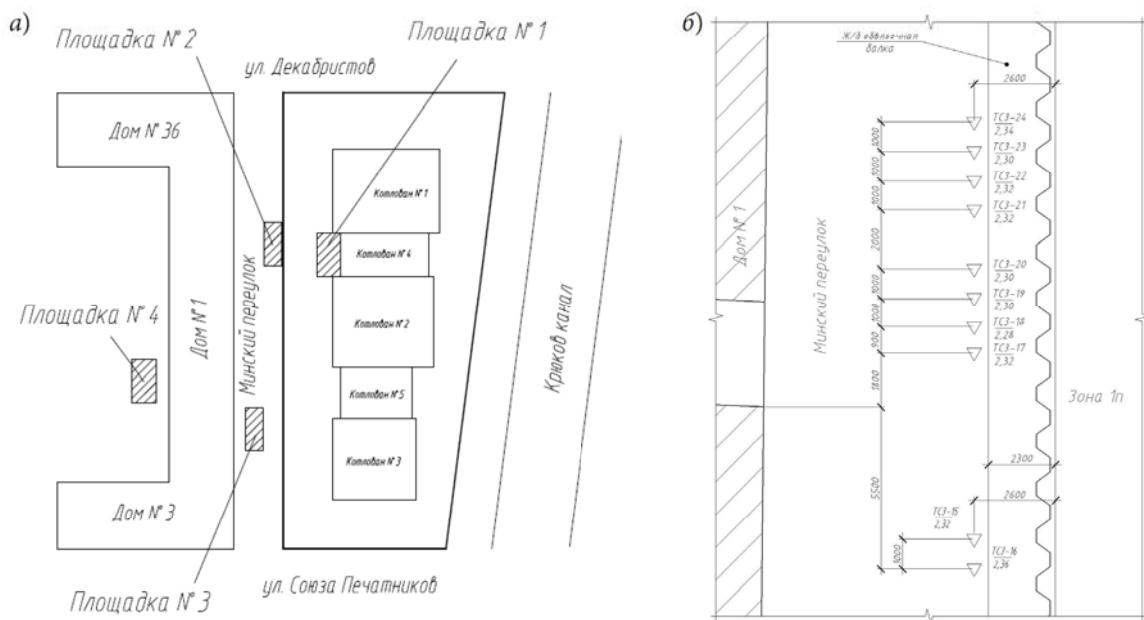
Схема размещения опытных площадок (а) и схема расположения точек зондирования на одной из площадок (б)
